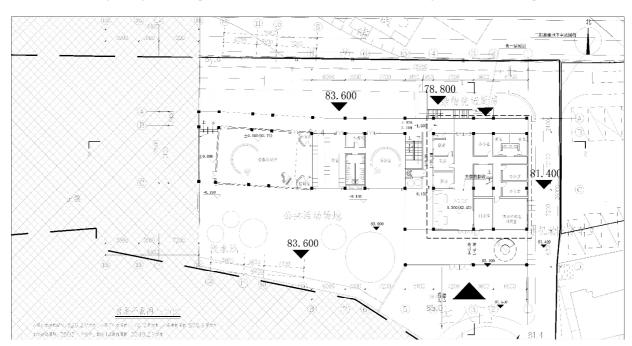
首层平面图(图片来源:作者自绘) Fig. 6 Ground floor plan
